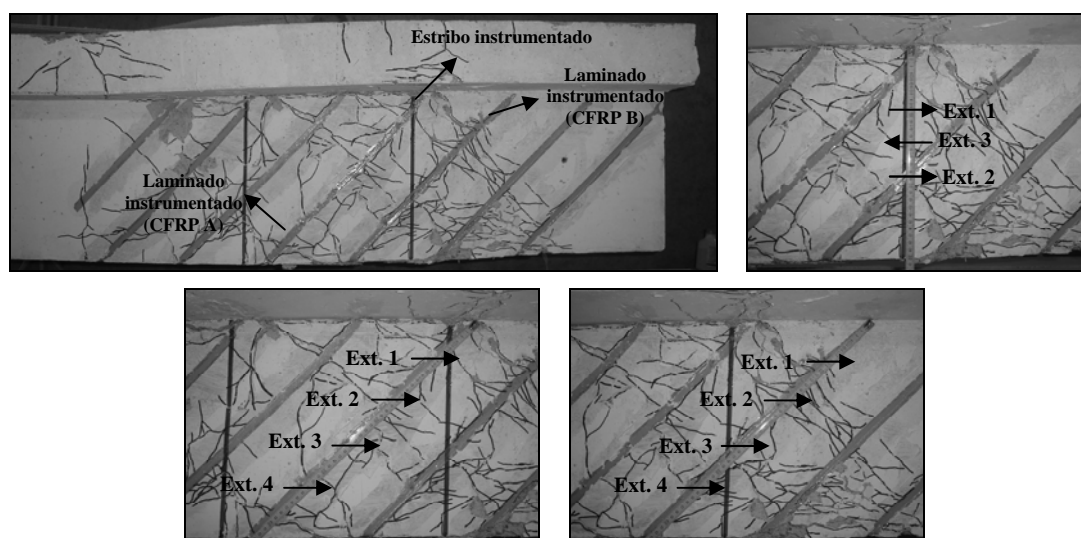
Localização dos extensómetros no laminado e estribo instrumentados da viga 2S-7LI45-C.
